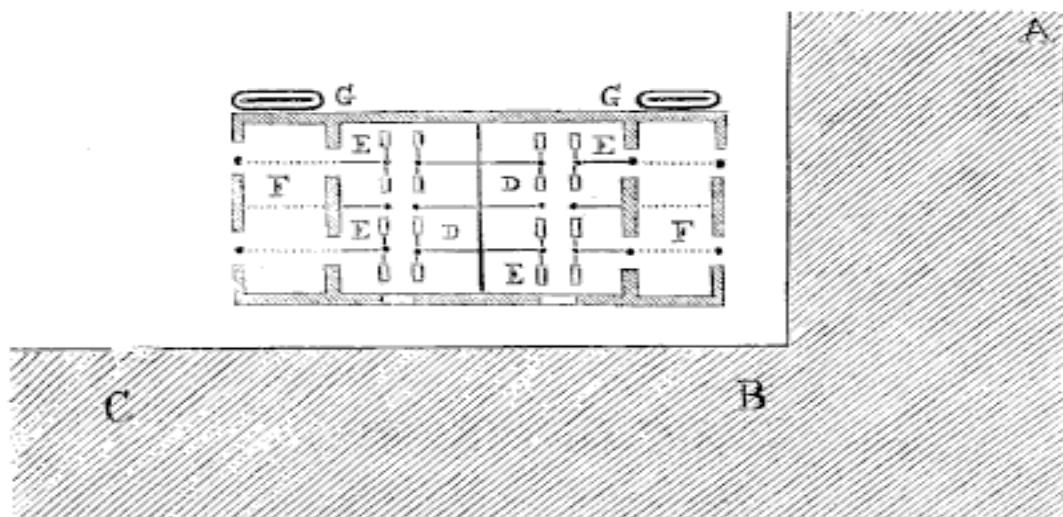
Plan général d'une porcherie placée dans la grande cour de ferme.
